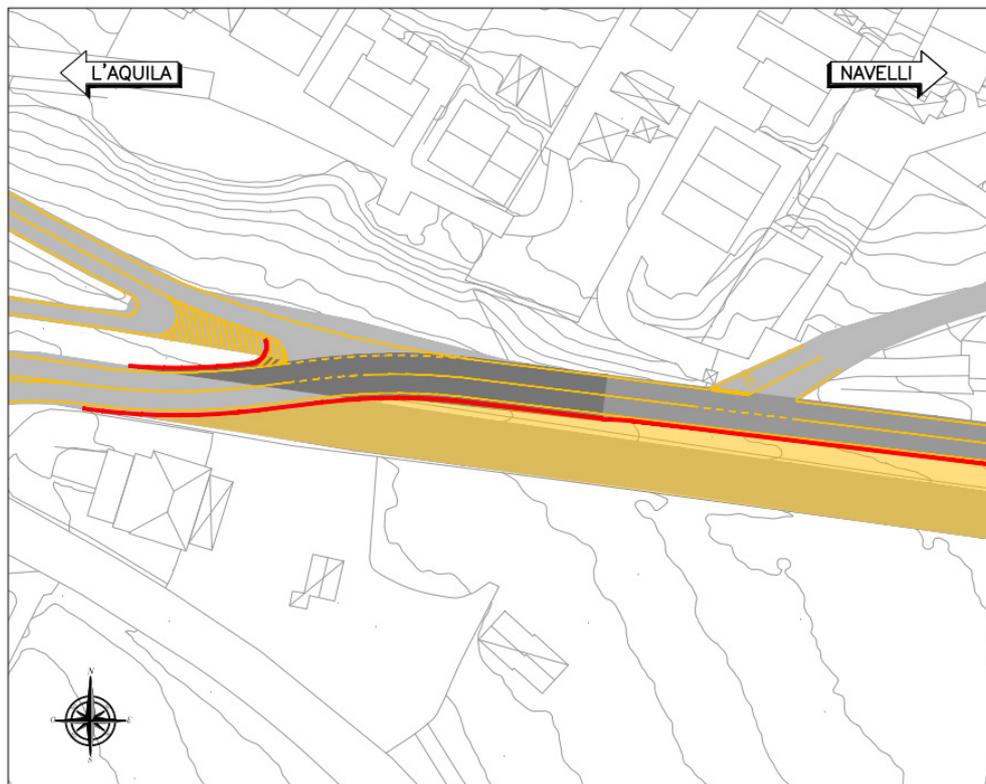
Brettezza A (fase 2) (Fonte: Allegato T00CA00CANDI00_B)
